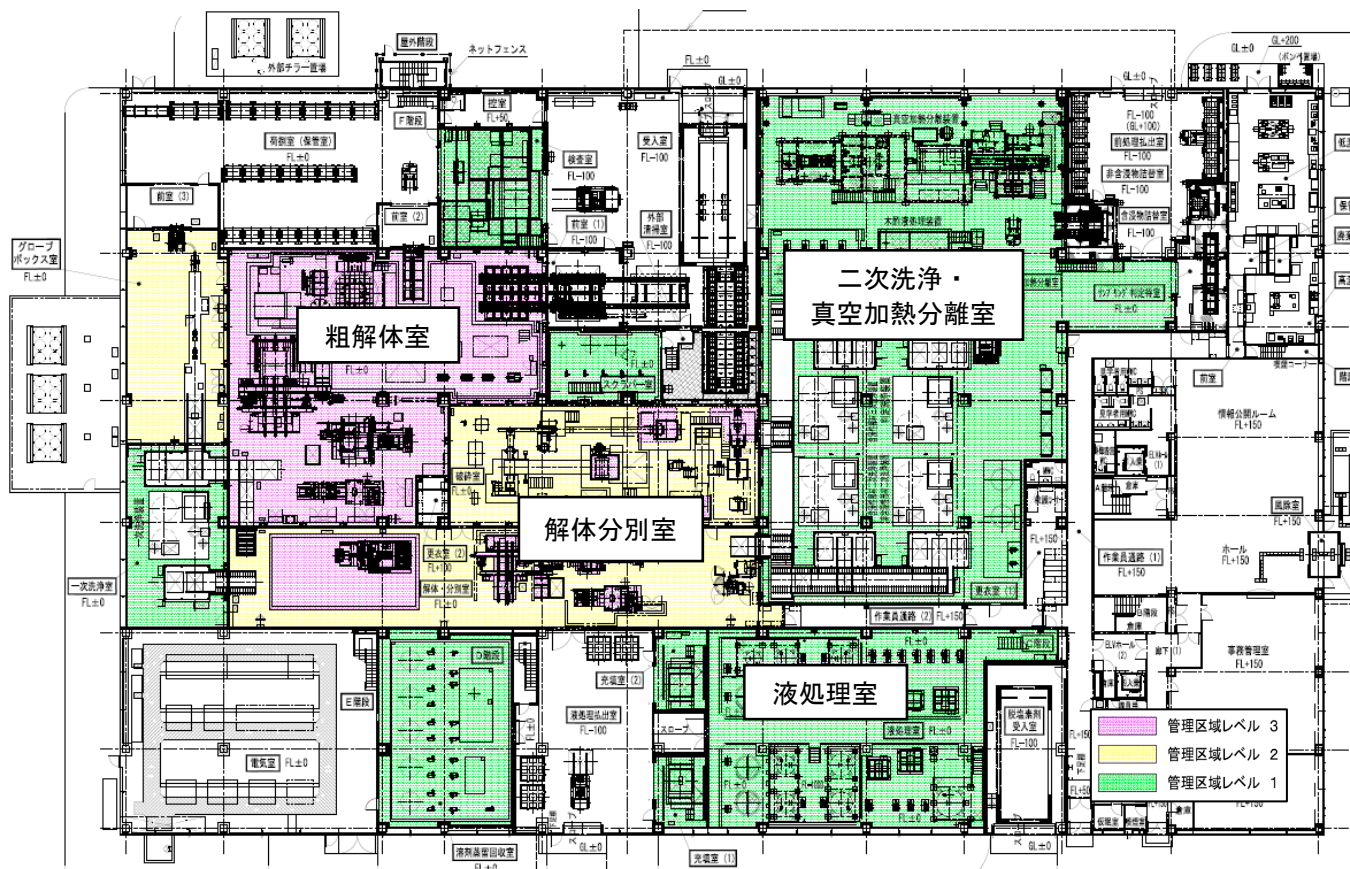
北九州事業所第 1 期施設の平面図（1 階）
